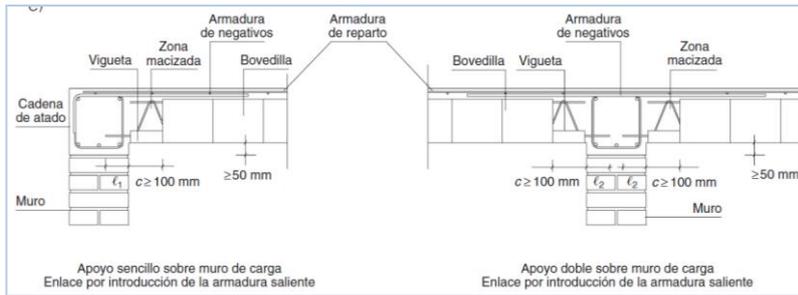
y 22. Apoyo sobre muro de carga. Enlace por introducción de la armadura saliente
